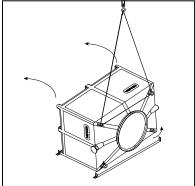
Colocando el cuerpo de la torre en posición para el ensamble
